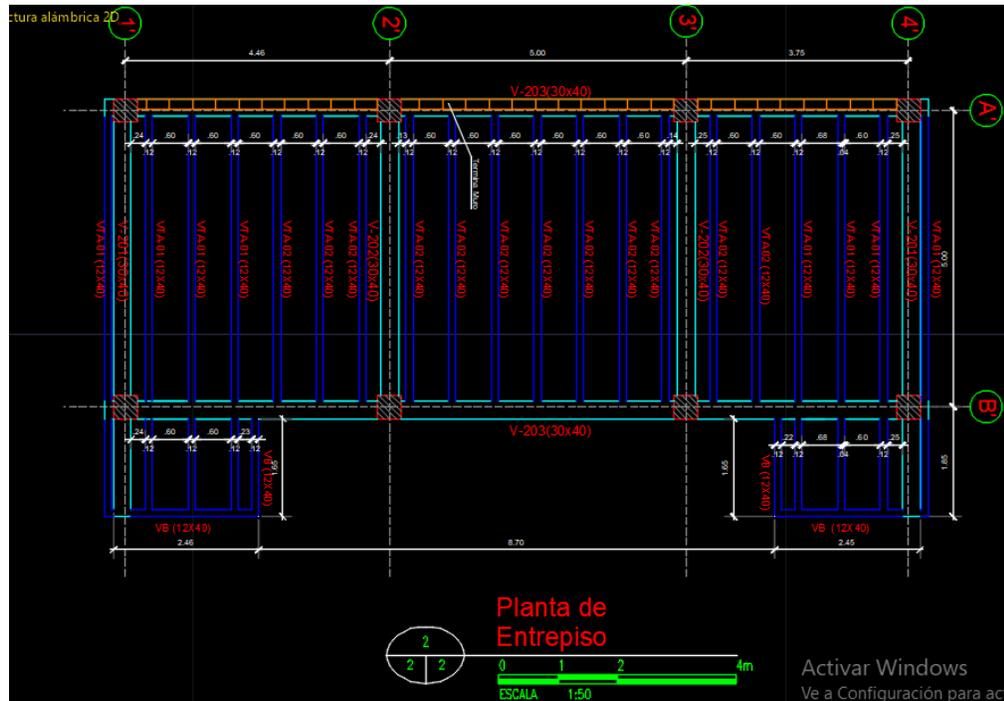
Planta placa de entrepiso Portería Reserva del Rosario.
